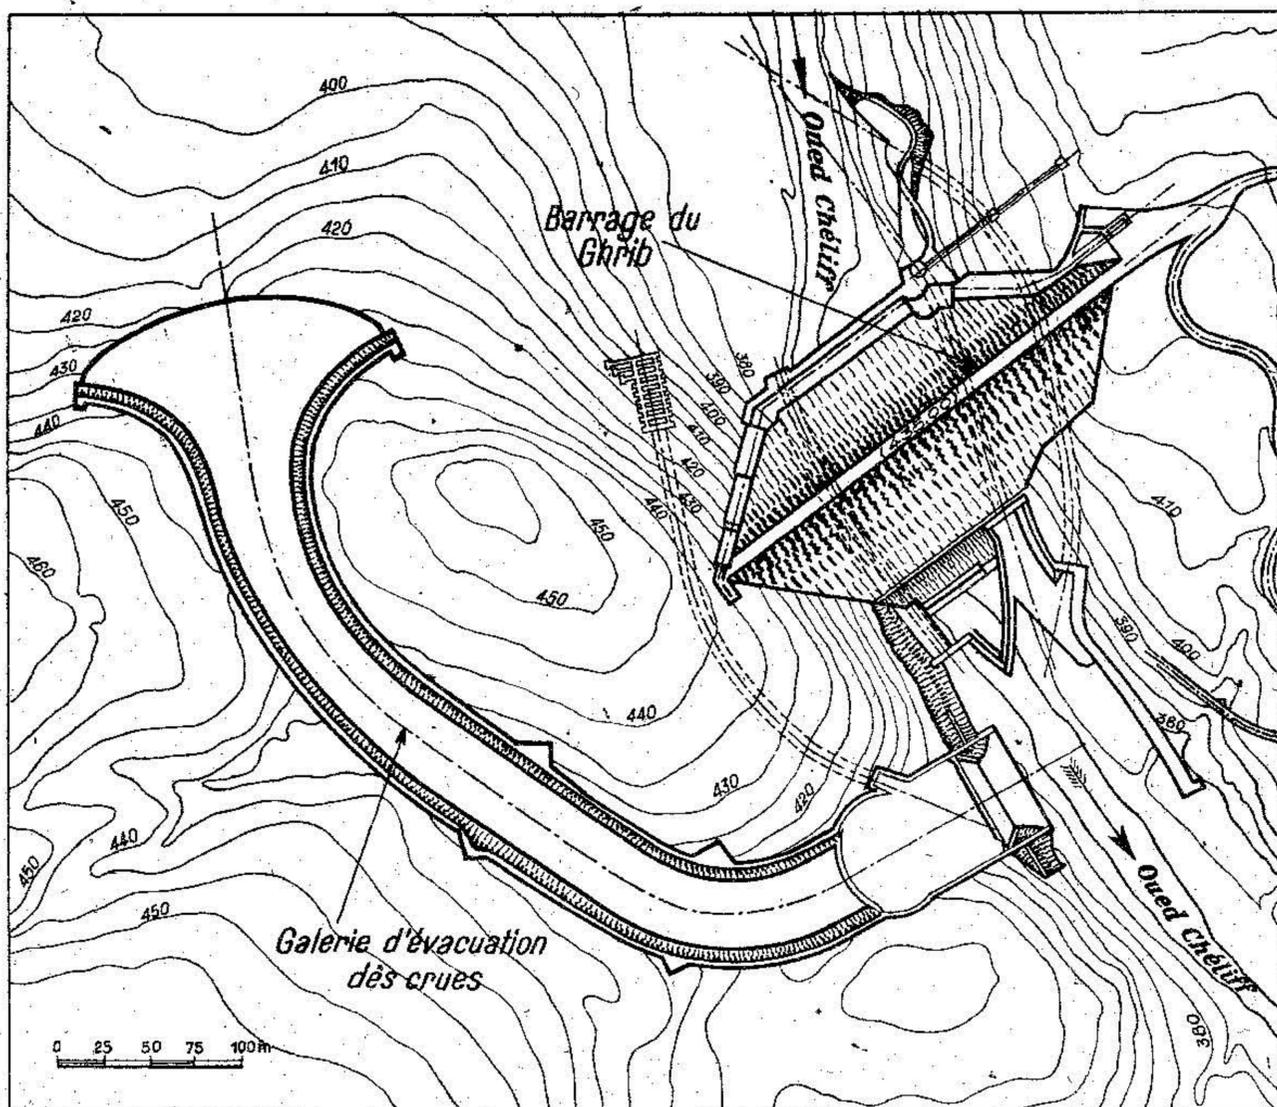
PLAN D'ENSEMBLE DU BARRAGE DU GHRIF.
